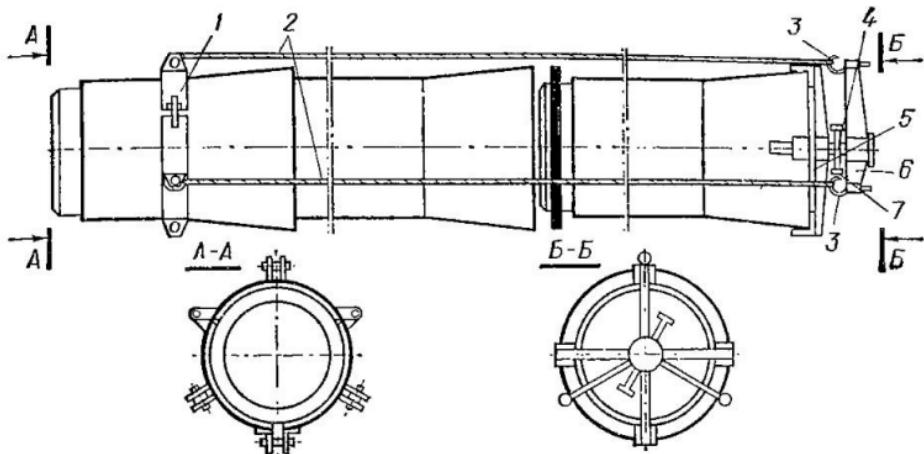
Монтаж труб с помощью натяжного приспособления винтового типа с шарнирным хомутом
